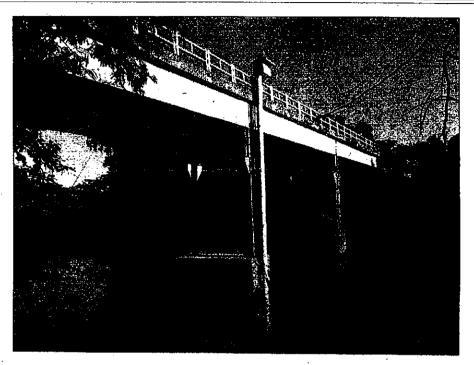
Vista lateral de jusante (lado Unal). Em primeiro plano está a ponte mais recente, construída em 1988.
